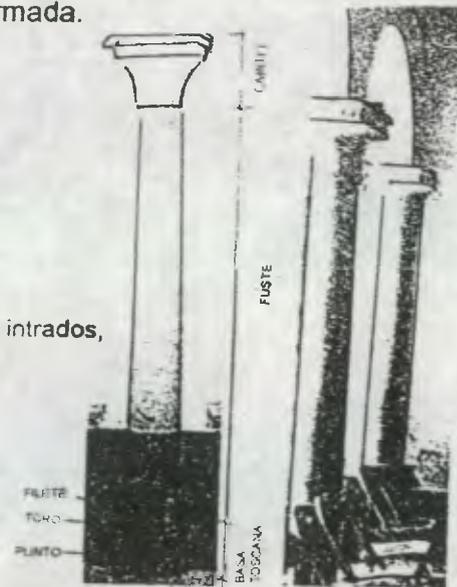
Detalle de columna, una de las doce que circundan el primer patio. Vista de columna, arcos y los intrados, parte interna del arco
